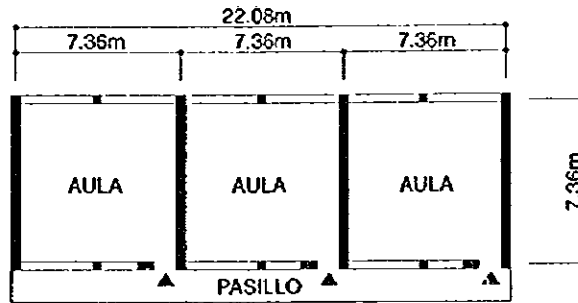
Plan superficial de edificio de tipo tres aulas con pared divisoria móvil
